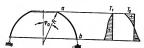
Внутренние усилия в открытой шаровой оболочке от собственного веса.
